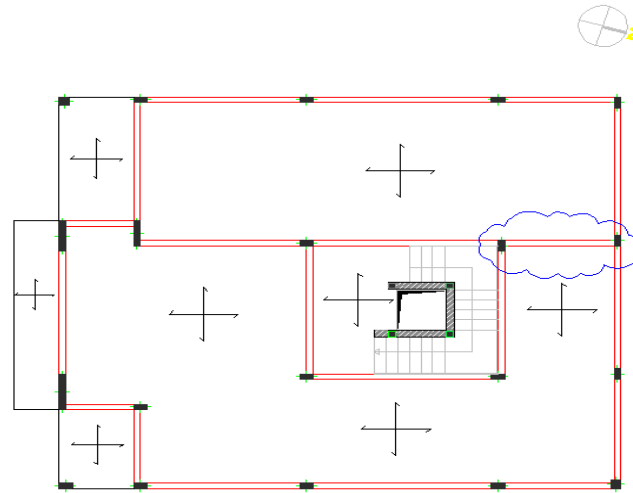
Alteração aos elementos da estrutura do pavimento do piso 1
